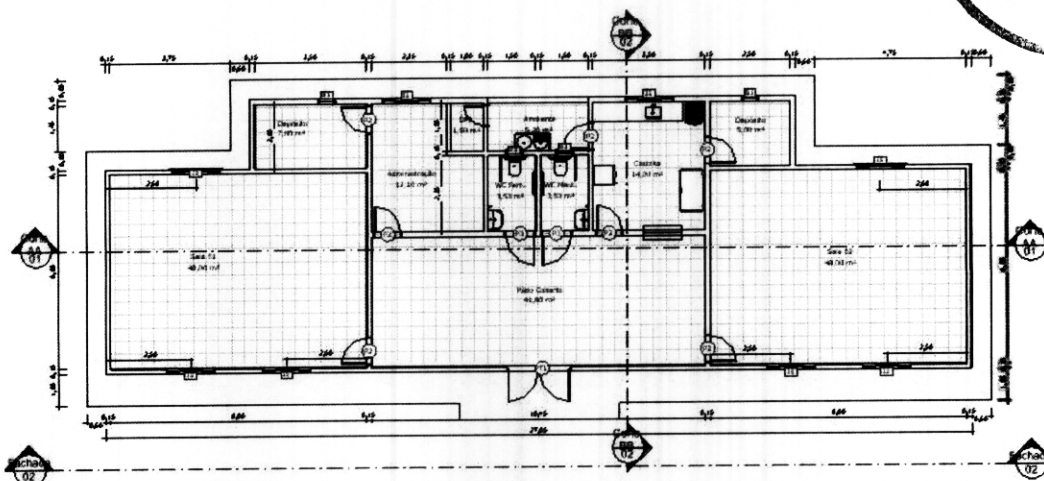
Projeto arquitetônico com área construída de 207,07m², contrato N° 152/2023; Planta baixa da escola de 02 salas e demais dependência, situado no Povoado Borrvalho.
